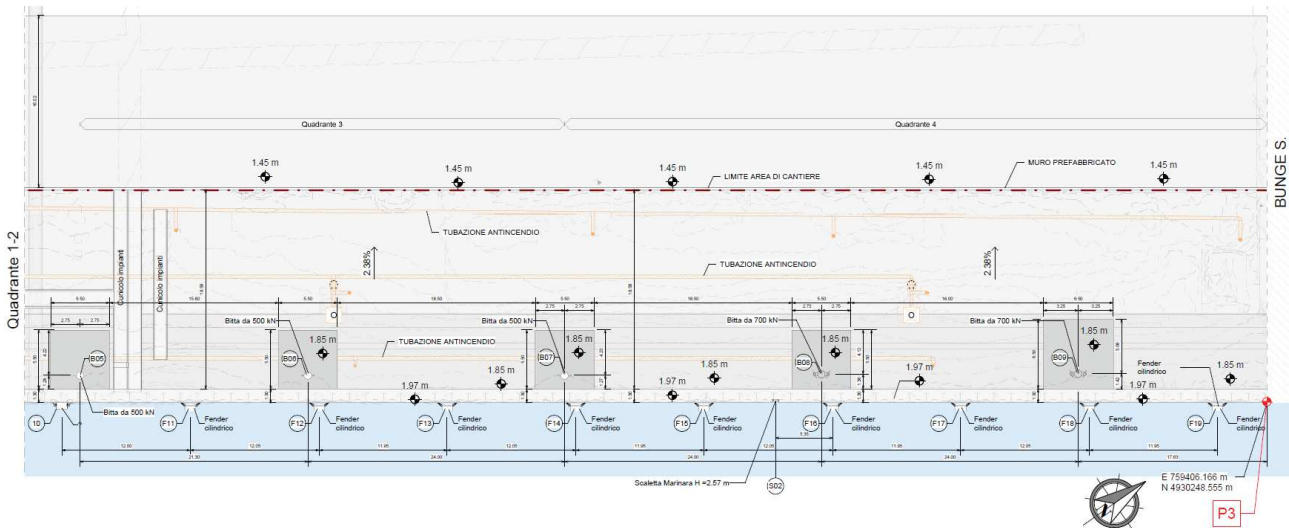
Pianta dello stato di fatto / Quadranti 3-4.
